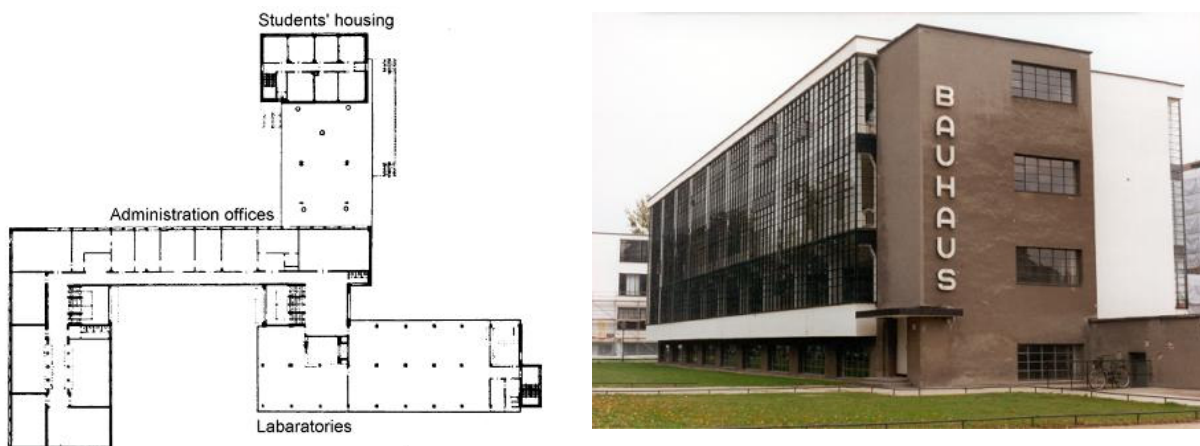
Planta e foto da sede da Bauhaus, em Dessau, projeto de Gropius e Meyer.
